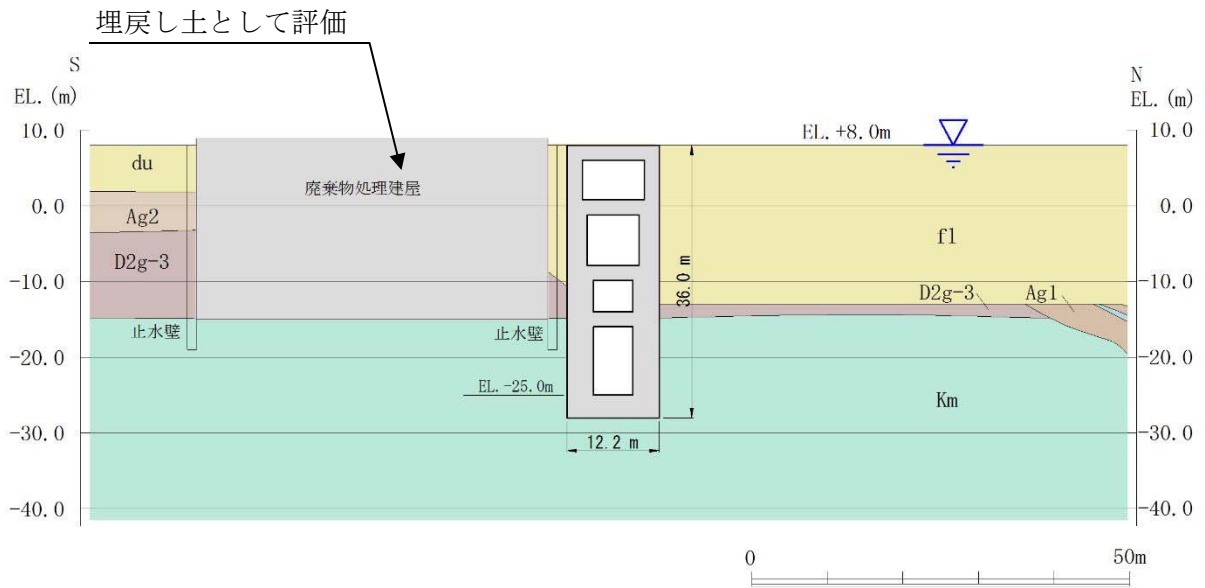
(2) 緊急用海水ポンプピット評価対象断面図 (南北方向断面)
